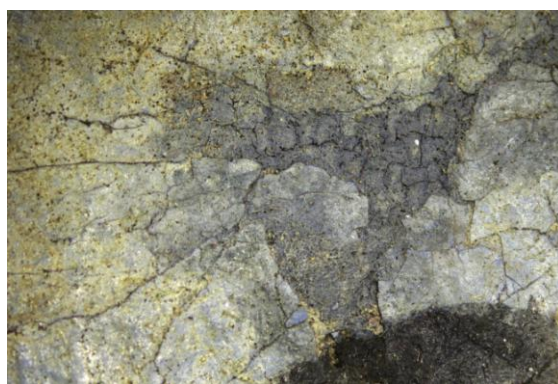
Barevná vrstva s degradovanou povrchovou úpravou
